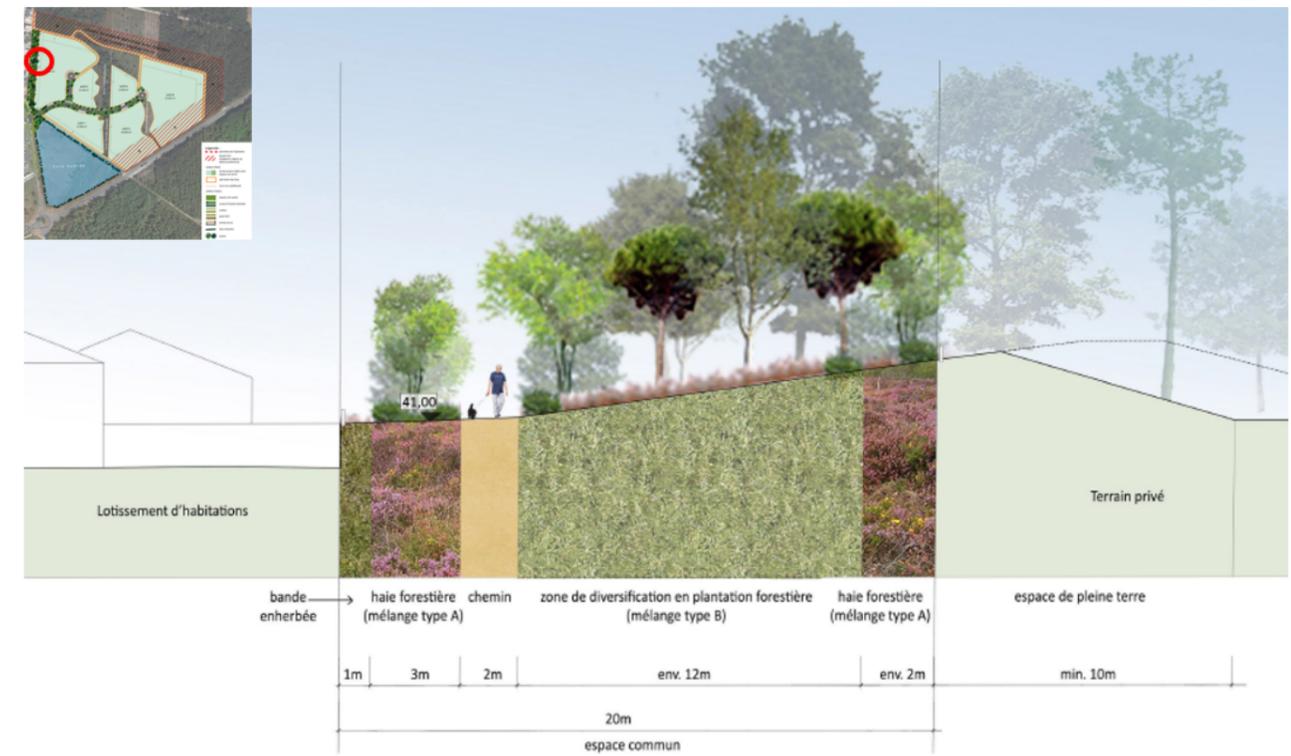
Coupe bande de 20 m en limite Ouest du projet
